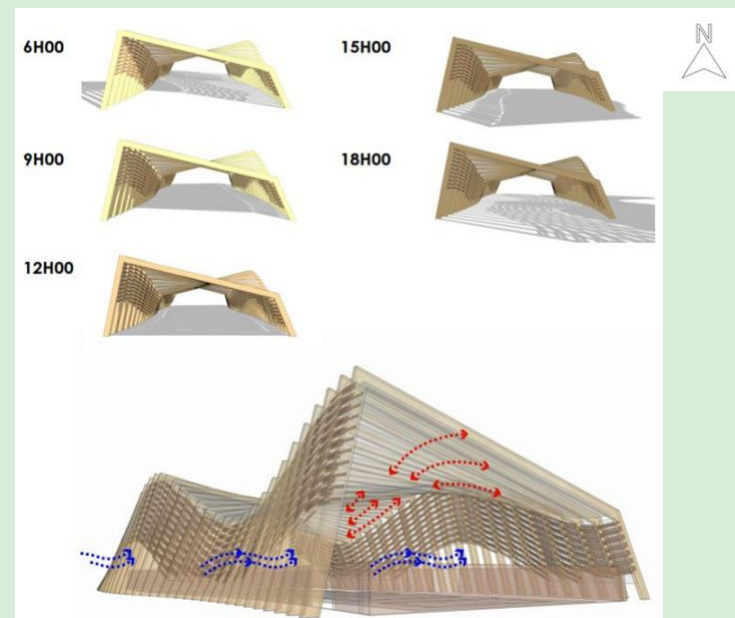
Plano de proyecto Chacras. Fuente: (Repositorio UCE, 2014)
